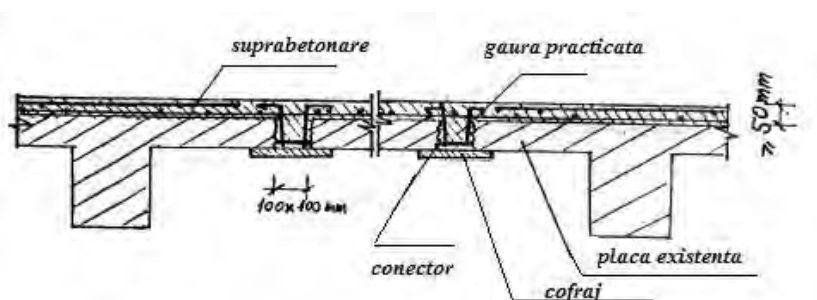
Consolidarea plăcilor din beton armat cu suprabetonare [76]
